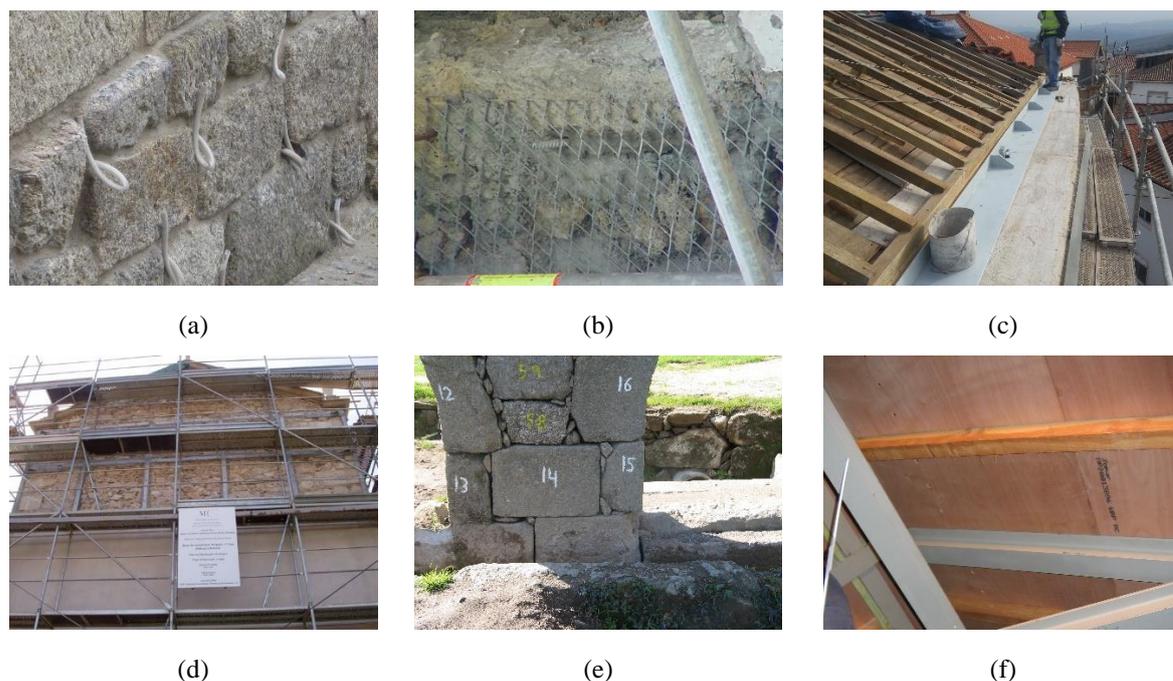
Técnicas de reforço estrutural: (a) Injeção; (b) Reboco armado; (c) Chapa de consolidação; (d) Estrutura metálica; (e) Numeração das pedras para o desmonte/remonte da estrutura; (f) Substituição de elementos degradados por elementos metálicos [Fotografias do IC/FEUP]
